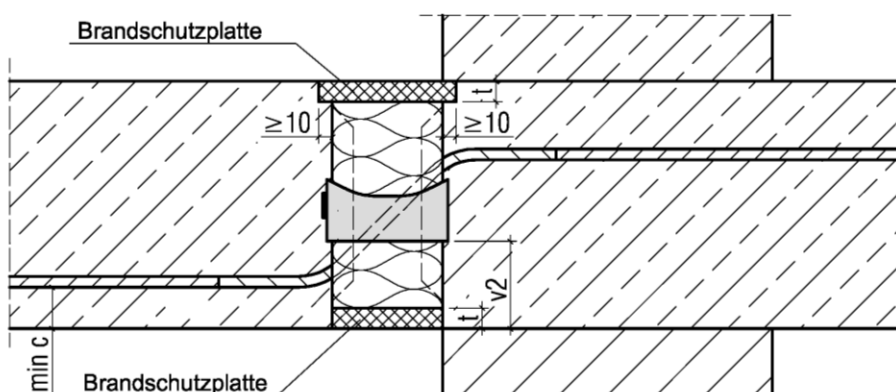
Schöck Isokorb® Typ Q (Ausführungsvariante A) gem. Abschnitt 3.1.2, Var. a)
